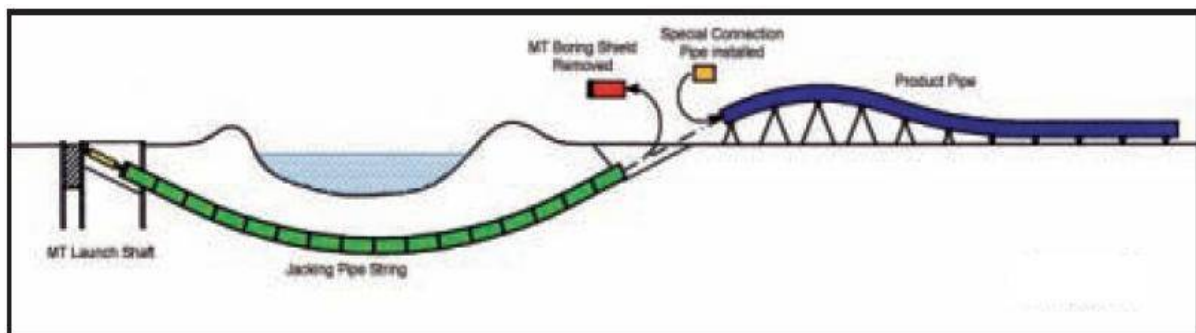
/8 - Schema di installazione con tecnologia “Easy Pipe”
